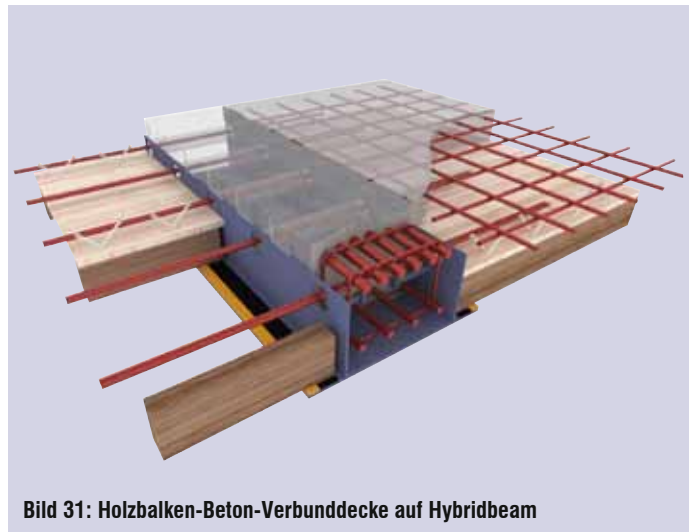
Holzbalken-Beton-Verbunddecke auf Hybridbeam
